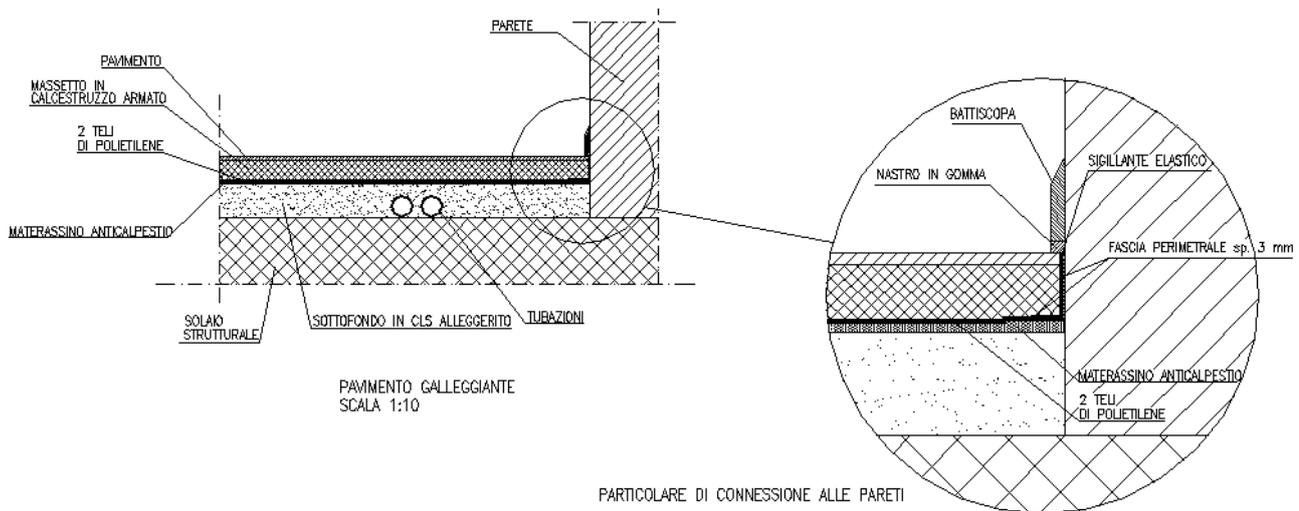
Ipotesi di collegamento tra la pavimentazione galleggiante e le altre strutture.
